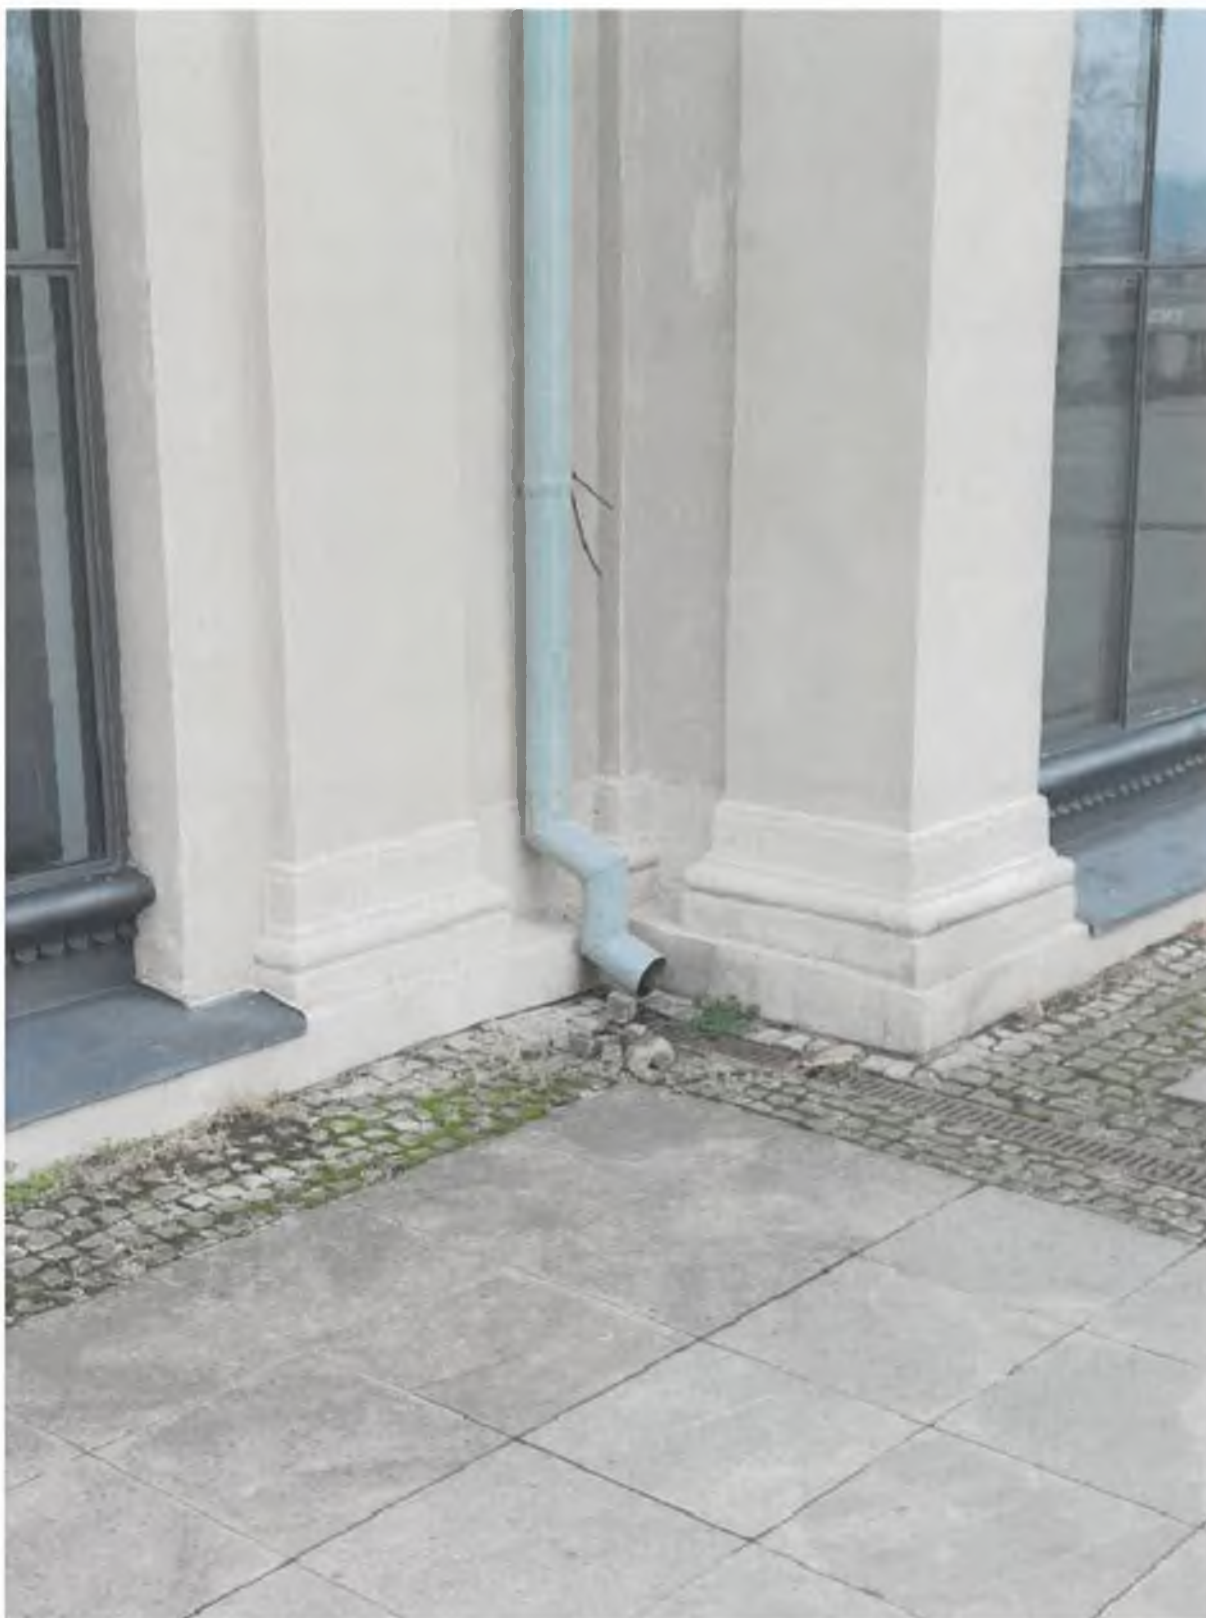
Venky – Odvodnění dešťů do liniového žlabu, okapový chodníček doporučeno řešit dlažbou
